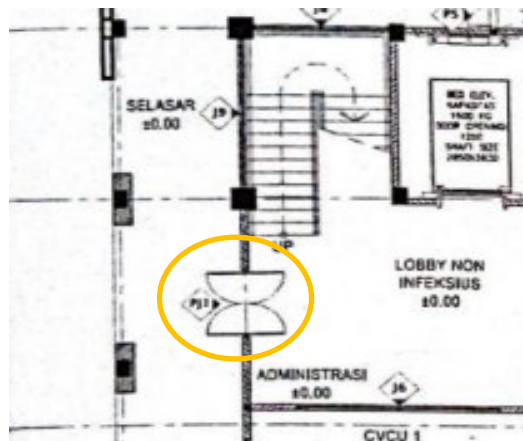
Denah Rencana Pintu Tipe PJ1.
